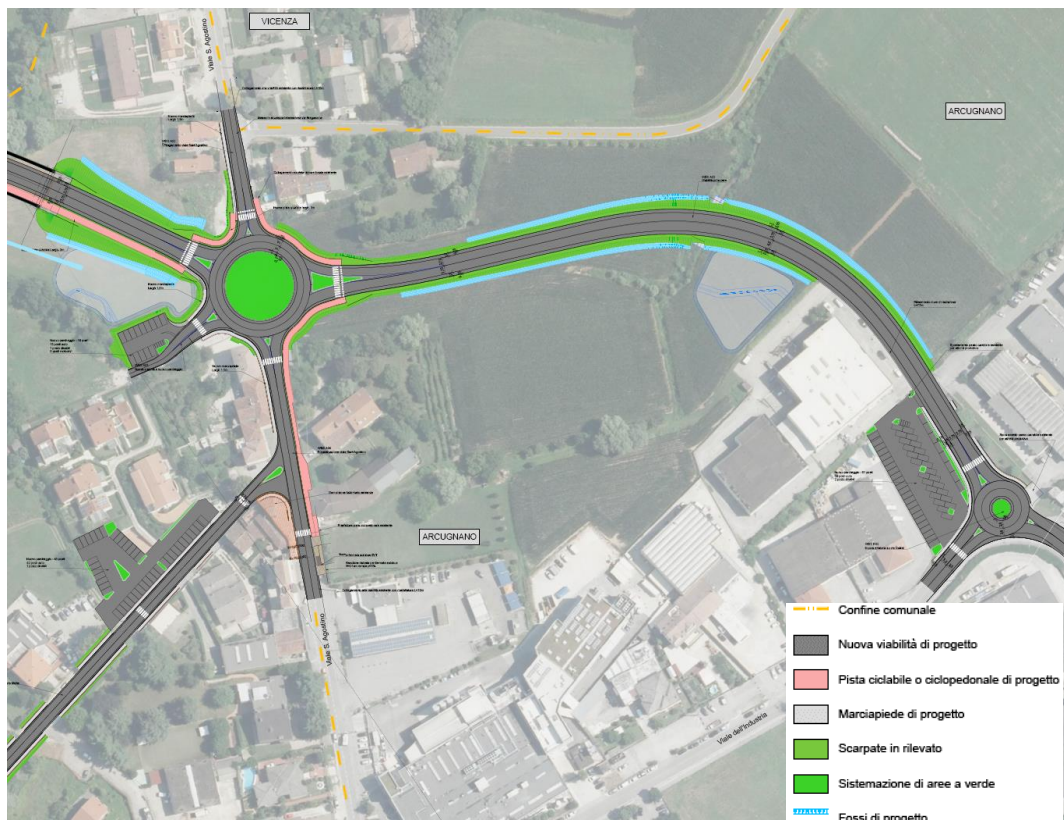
Planimetria del Ponte sul Retrone e Collegamento via S. Agostino - Z.I. Arcugnano
